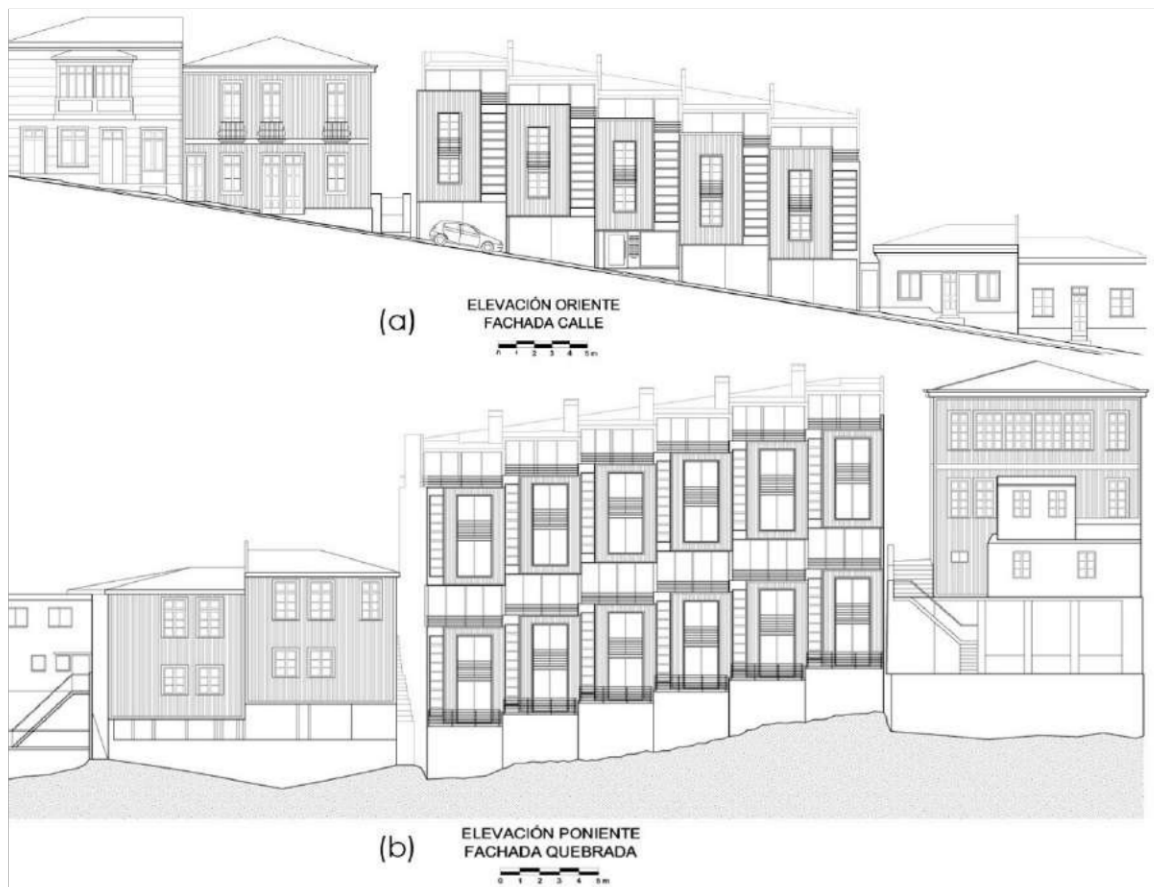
Elevación oriente y poniente, desfases de niveles en las dos fachadas // Fuente: (Mendizábal, 2009).
